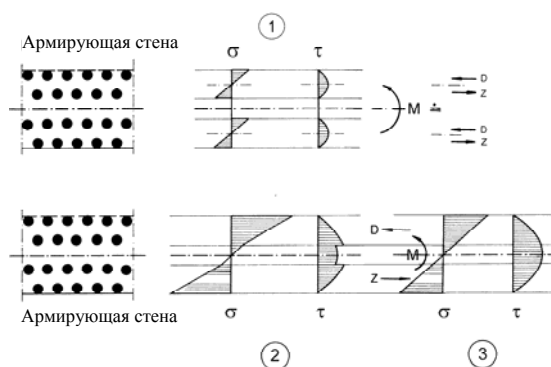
Распределение напряжения по армирующей стене (схема): разный связующий эффект между грунтом и рядами свай: 1 – отсутствие сцепления между грунтом и рядами свай; 3 – полное сцепление
